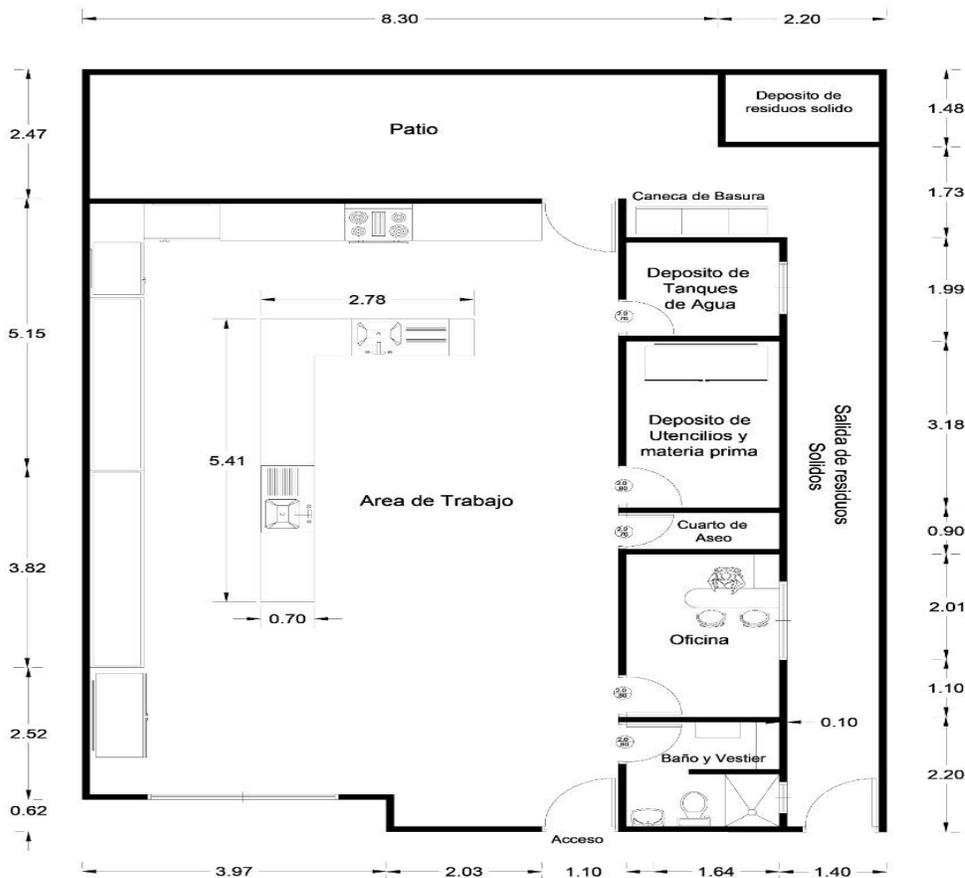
Diseño de plano de planta procesadora AutoCAD 2D.
